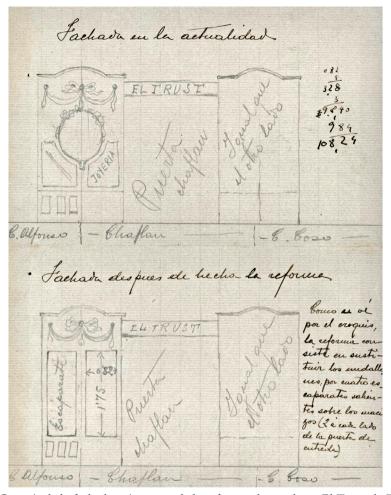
Croquis de la fachada existente y de la reforma planteada en El Trust de Zaragoza. 1913. AMZ
